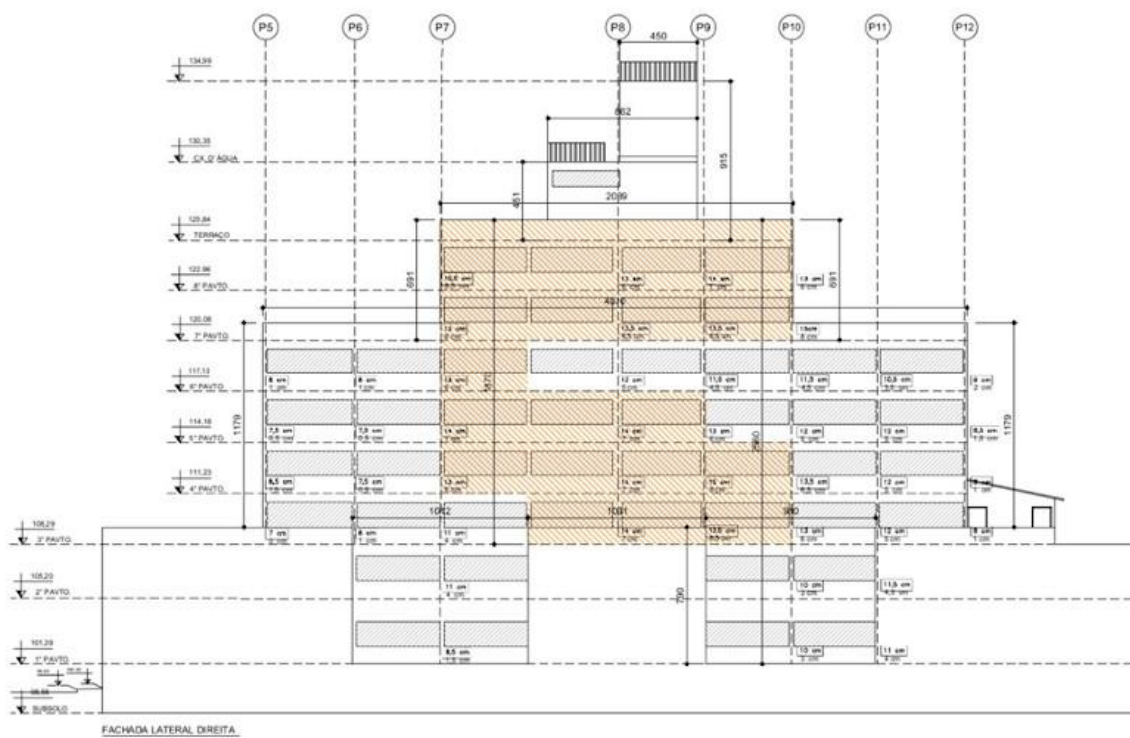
Levantamento dos prumos da fachada lateral direita demonstrando diferenças de enchimento do reboco acima de 7 cm.
